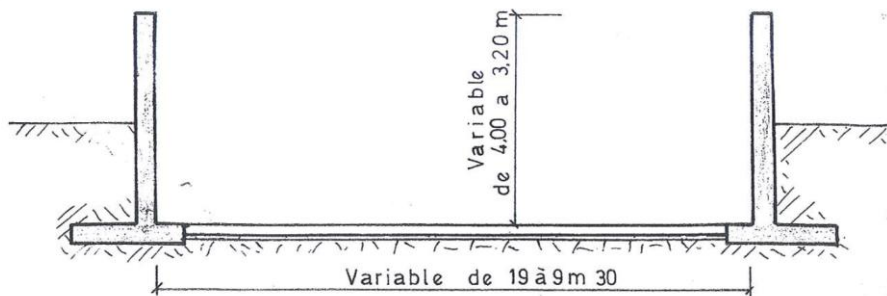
Coursier avec un radier et des bajoyers avec semelles en béton
